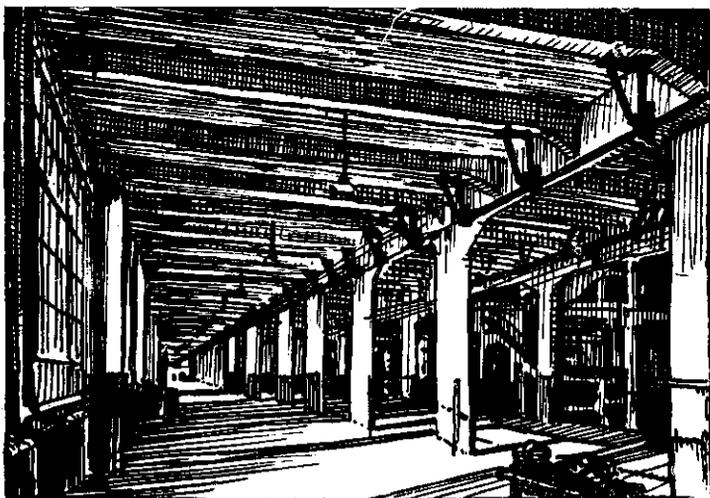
Железо-бетонное перекрытие с пустотами для облегчен. общего веса.
